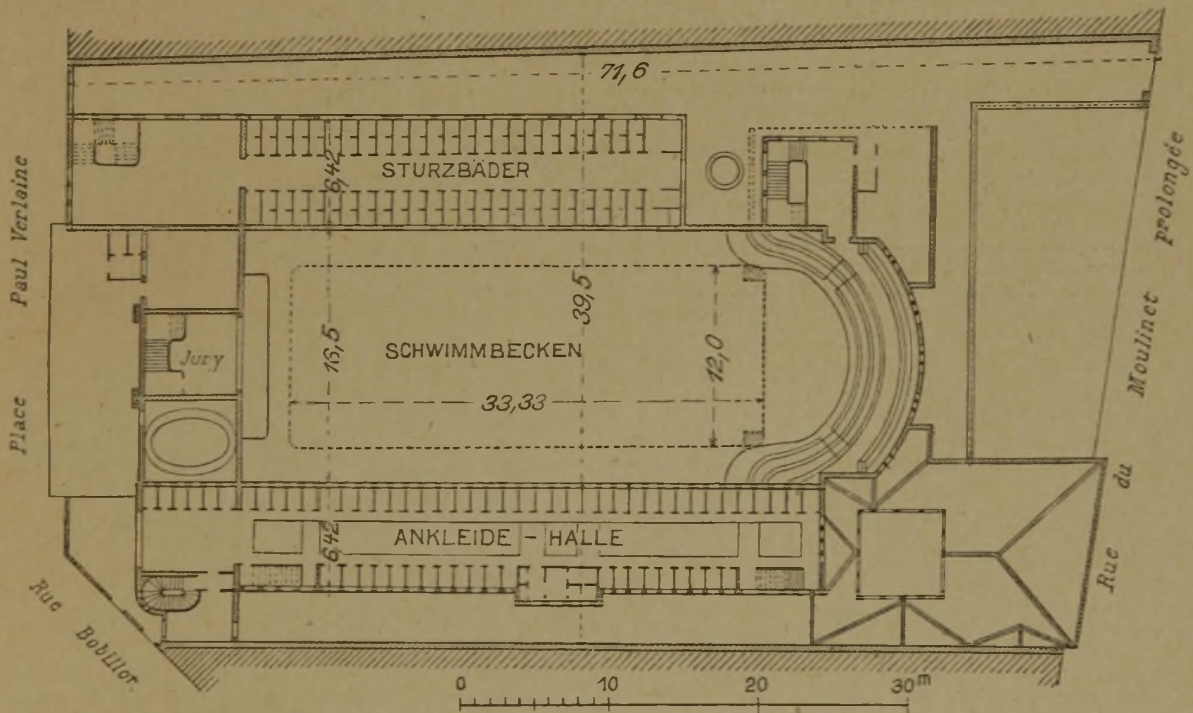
Grundriß der Badeanstalt. (1 : 50.)
